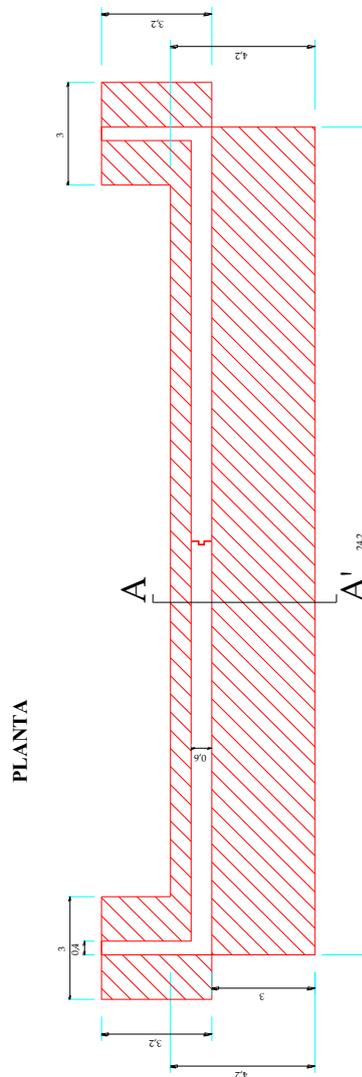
DETALLES DE ESTRIBOS PROPUESTOS EN LA RECONSTRUCCIÓN DEL PUENTE 17 DE SEPTIEMBRE.
